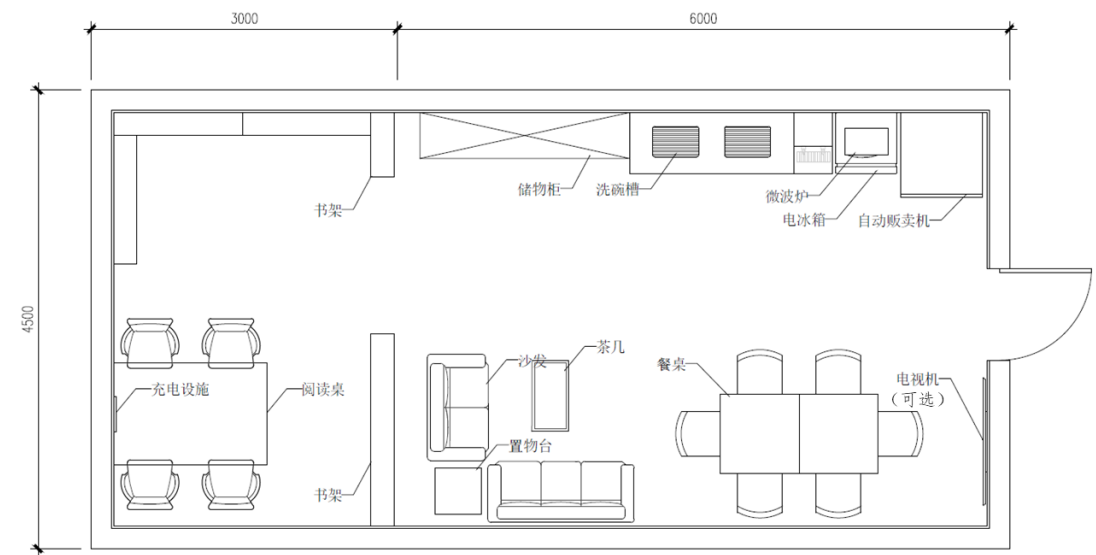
航站区共享休息区+阅览室 平面布局示意图（单位：mm）
